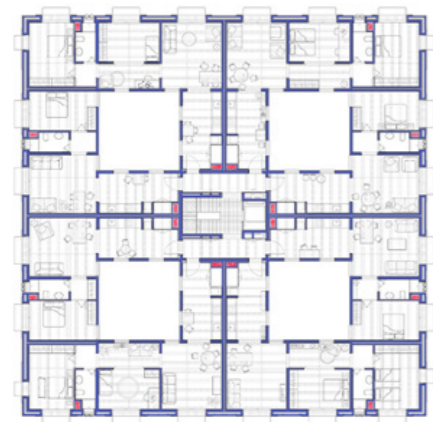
Planta tipo con instalaciones y muros rígidos.
